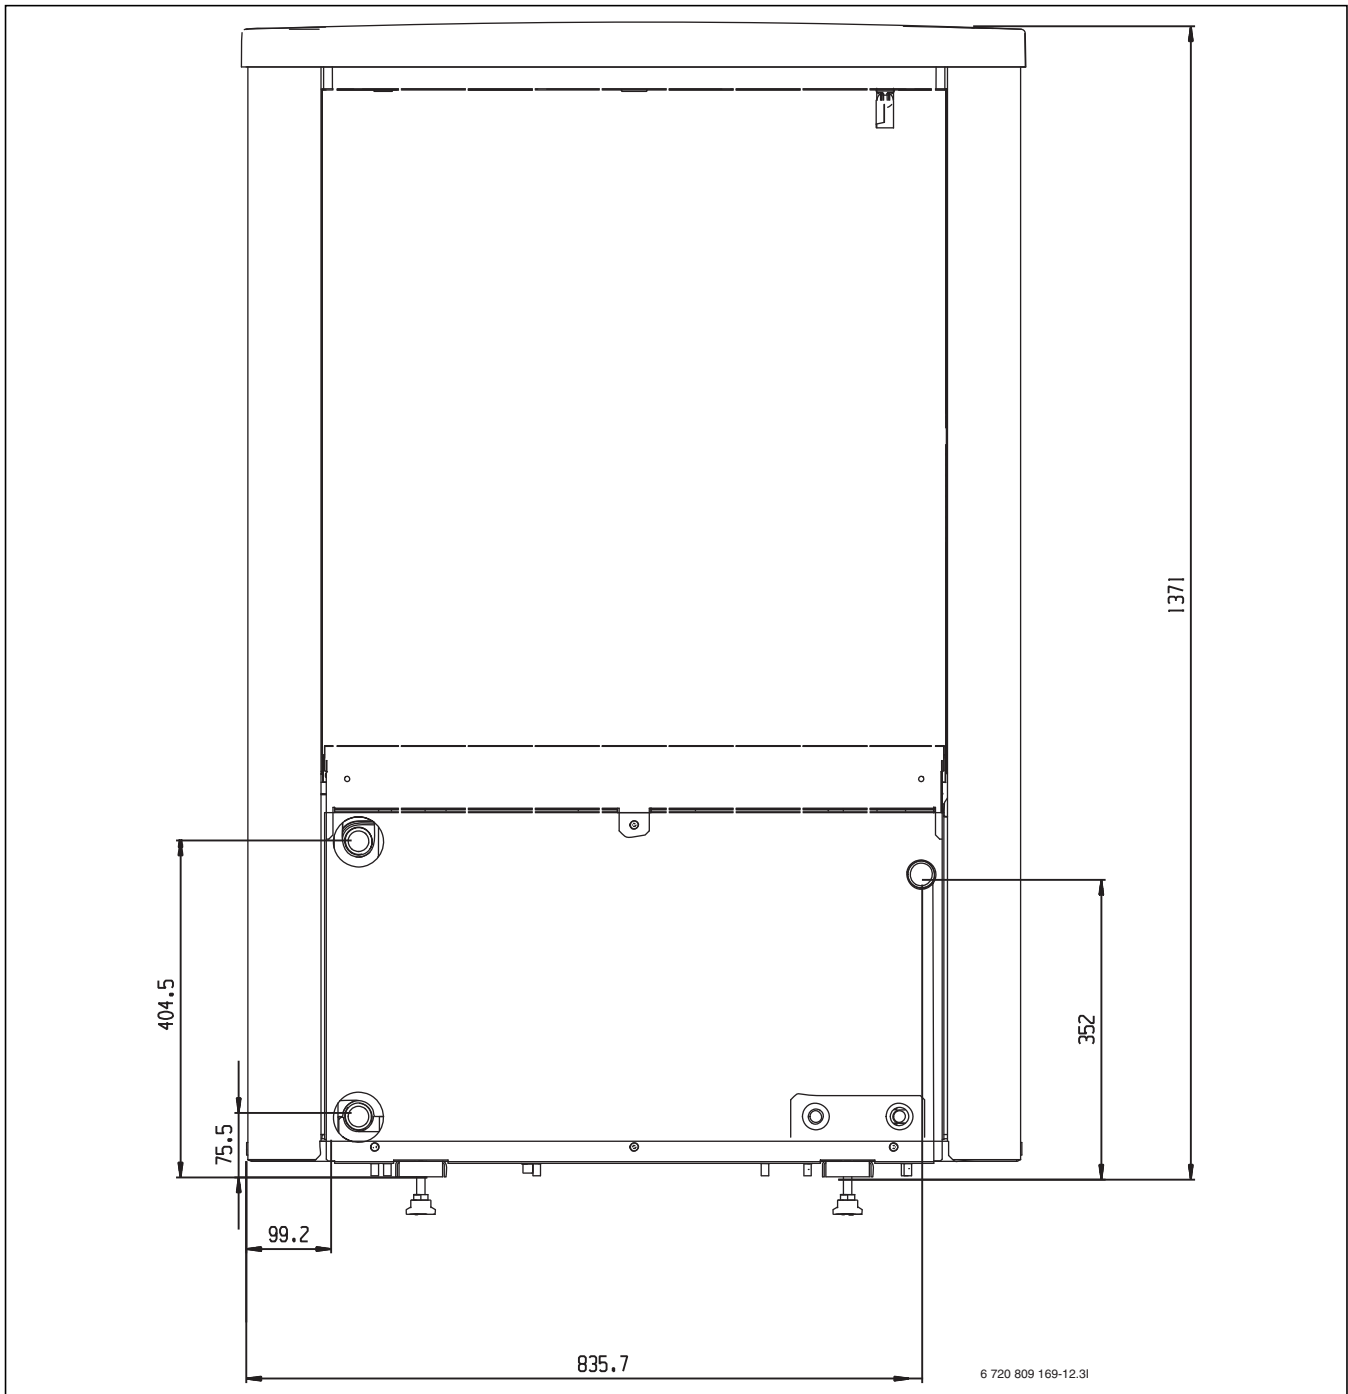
Dimensioni e attacchi del modello di pompa di calore AW 5-9, lato posteriore
